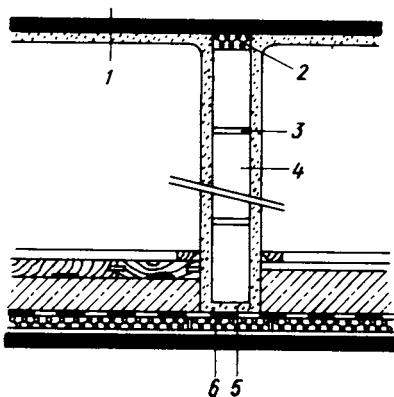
Армированная кирпичная перегородка (из четвертей кирпича)
